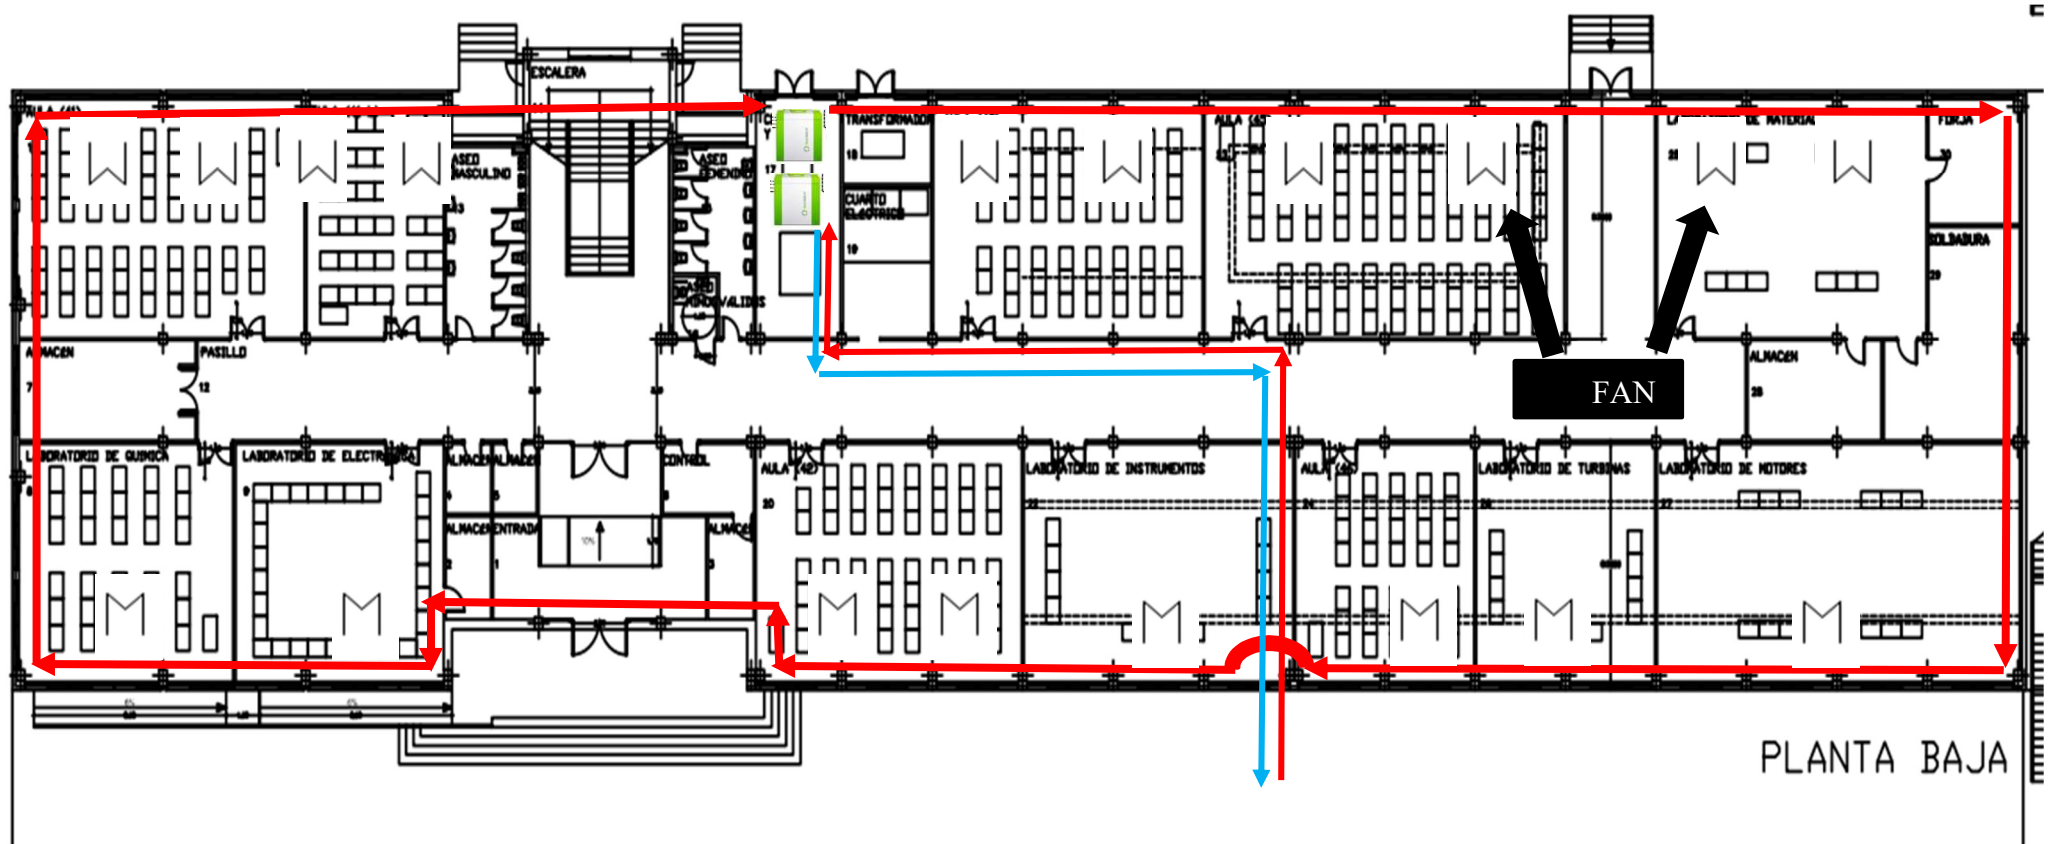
Esquema de instalación del sistema de climatización hidrotérmico en primera planta. Elaboración propia
